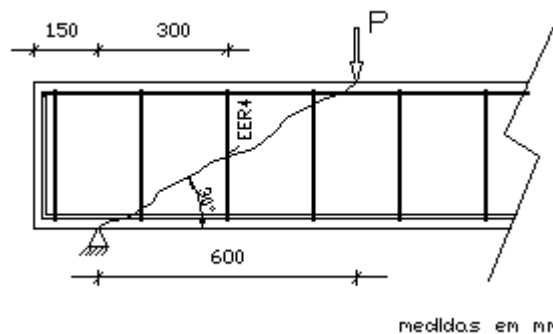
Extensômetros nos estribos das vigas VM1, VPF7, VPF8 e VPF9
